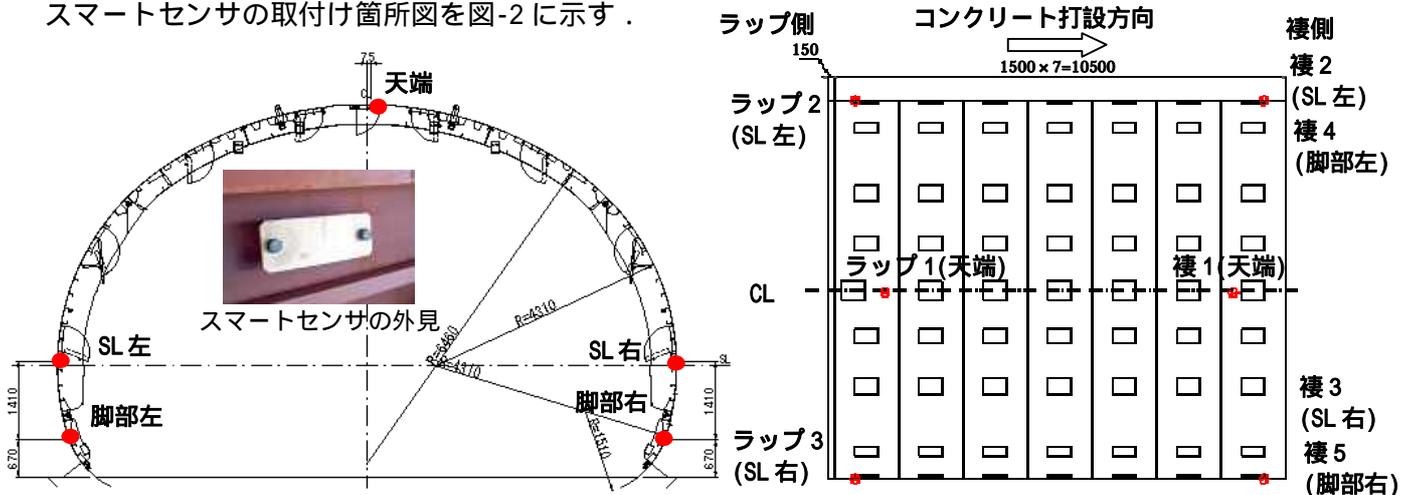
スマートセンサの取付け箇所図(断面図及び平面図)
